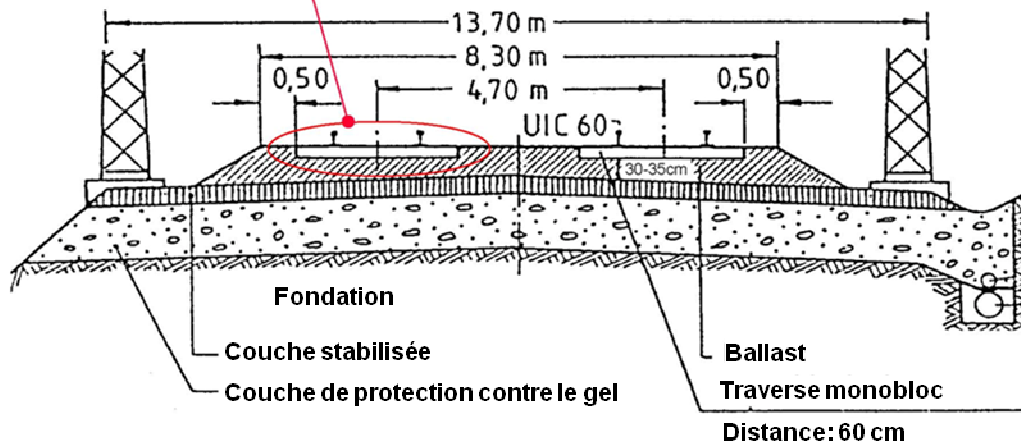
Coupe transversale d'une voie sur Ballast (Mißler, [8])
